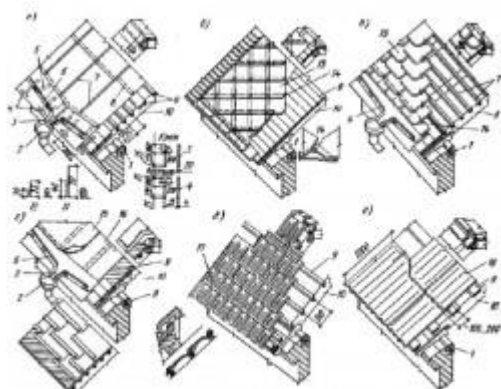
Кровли скатных крыш: а — из кровельной стали, б, в — ю плоской асбестоцементной плитки, г — рулонная, д — черепичная, е — из волнистых асбеста цементных листов, 1 — мауэрлат, 2 — водосточная воронка, 3 — желоб, 4 — костыли, 5 — крюк, 6 — настенные желиба, 7 — стоячий фальц, 8 — лежащий фальц, 9 — обрешетка, 10 — стропильные ноги, 11 — двойной стоячий фальц, 12 — одинарный стоячий фальц, 13 — асбестоцементные листы, 14 — крепежная деталь, 15 — рубероид, 16 — пергамик, 17 — черепица, 18 — листы асбестоцемента
